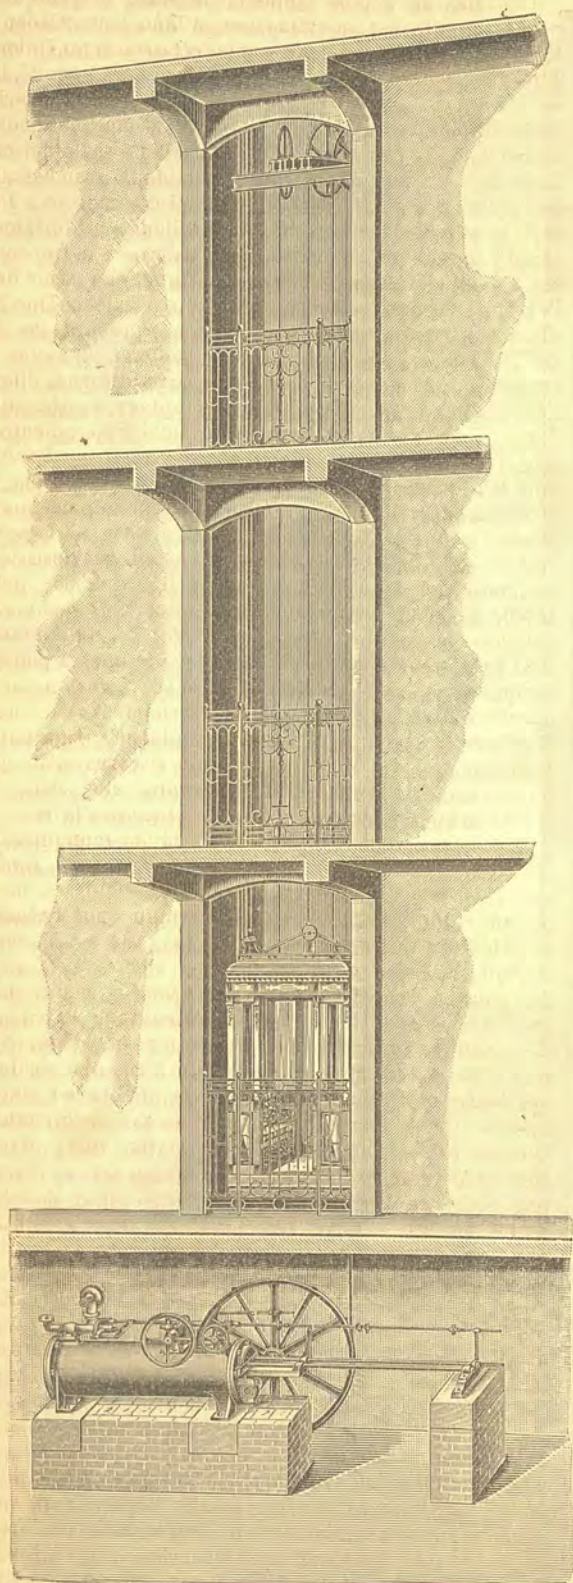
Disposizione di un ascensore sistema Stigler con macchina idraulica orizzontale.
